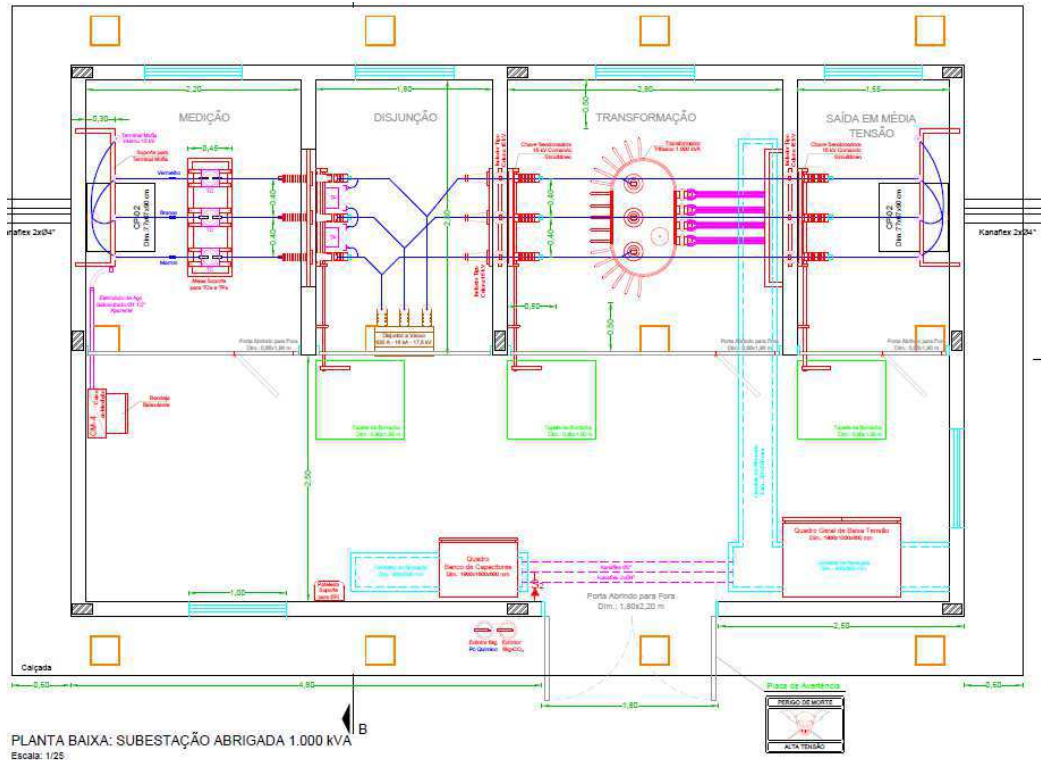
Planta baixa subestação abrigada 1 000kVA.
